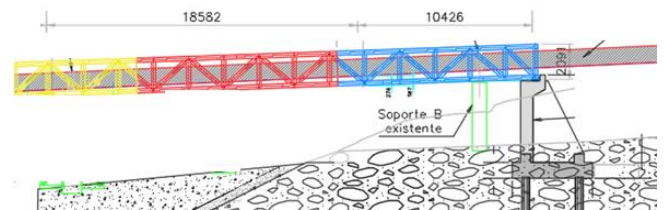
Espacio Disponible Margen Norte (Bastión 2). *Plan de Construcción MECO y STEEL.
